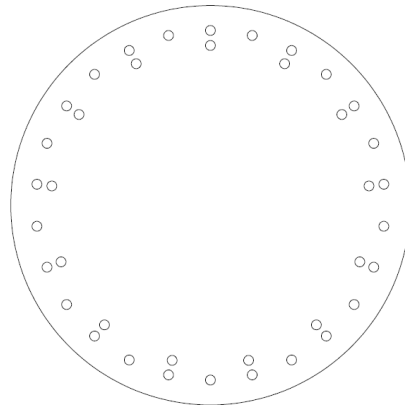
disposizione armatura longitudinale ($26+13F30$) pali nuovi
